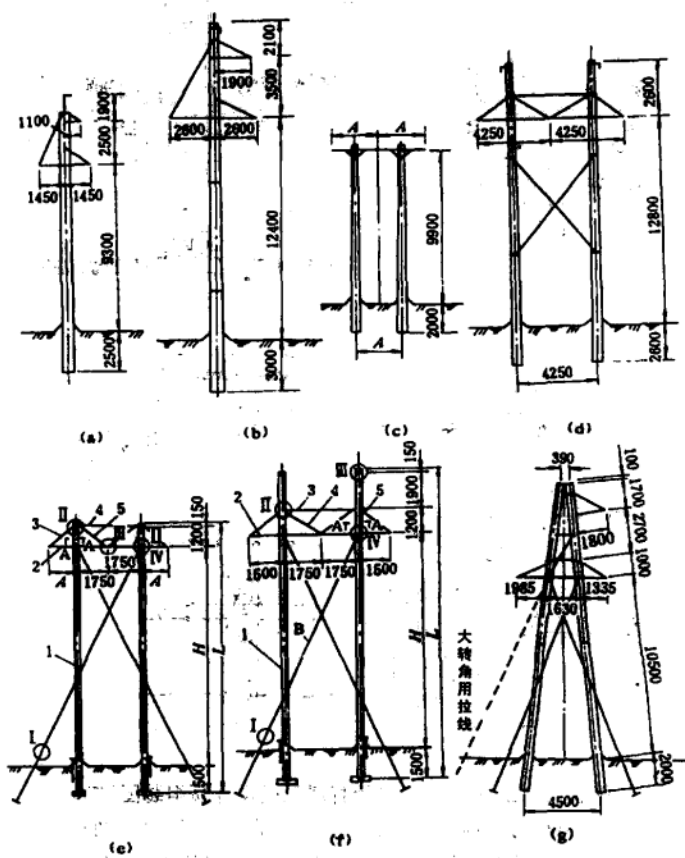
常用 35~110kV 钢筋混凝土杆塔型式图
